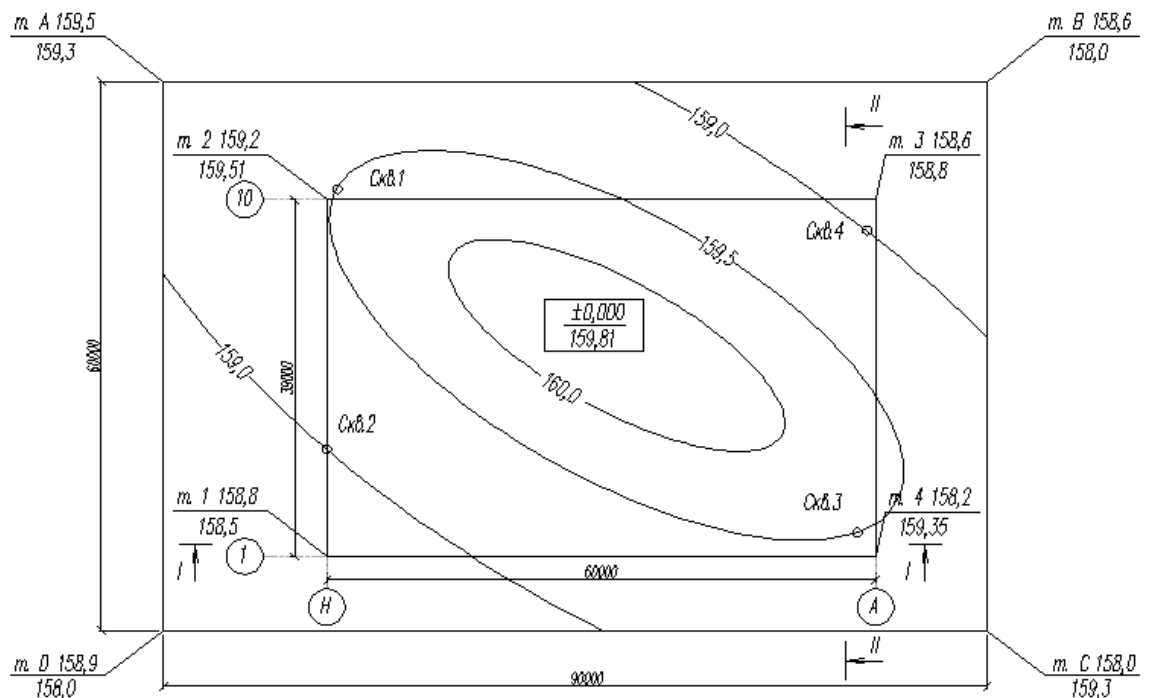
Схема плана строительной площадки и геологических выработок
